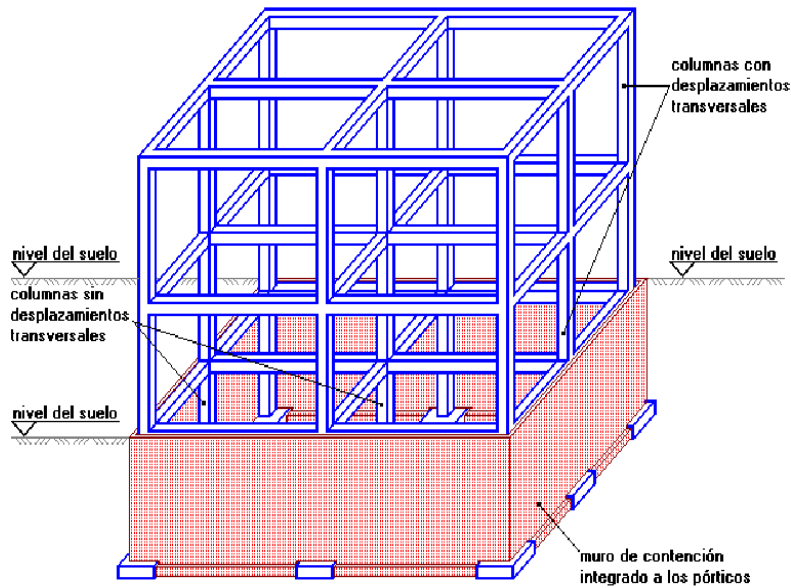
Representación de columnas con y sin desplazamiento transversal.
